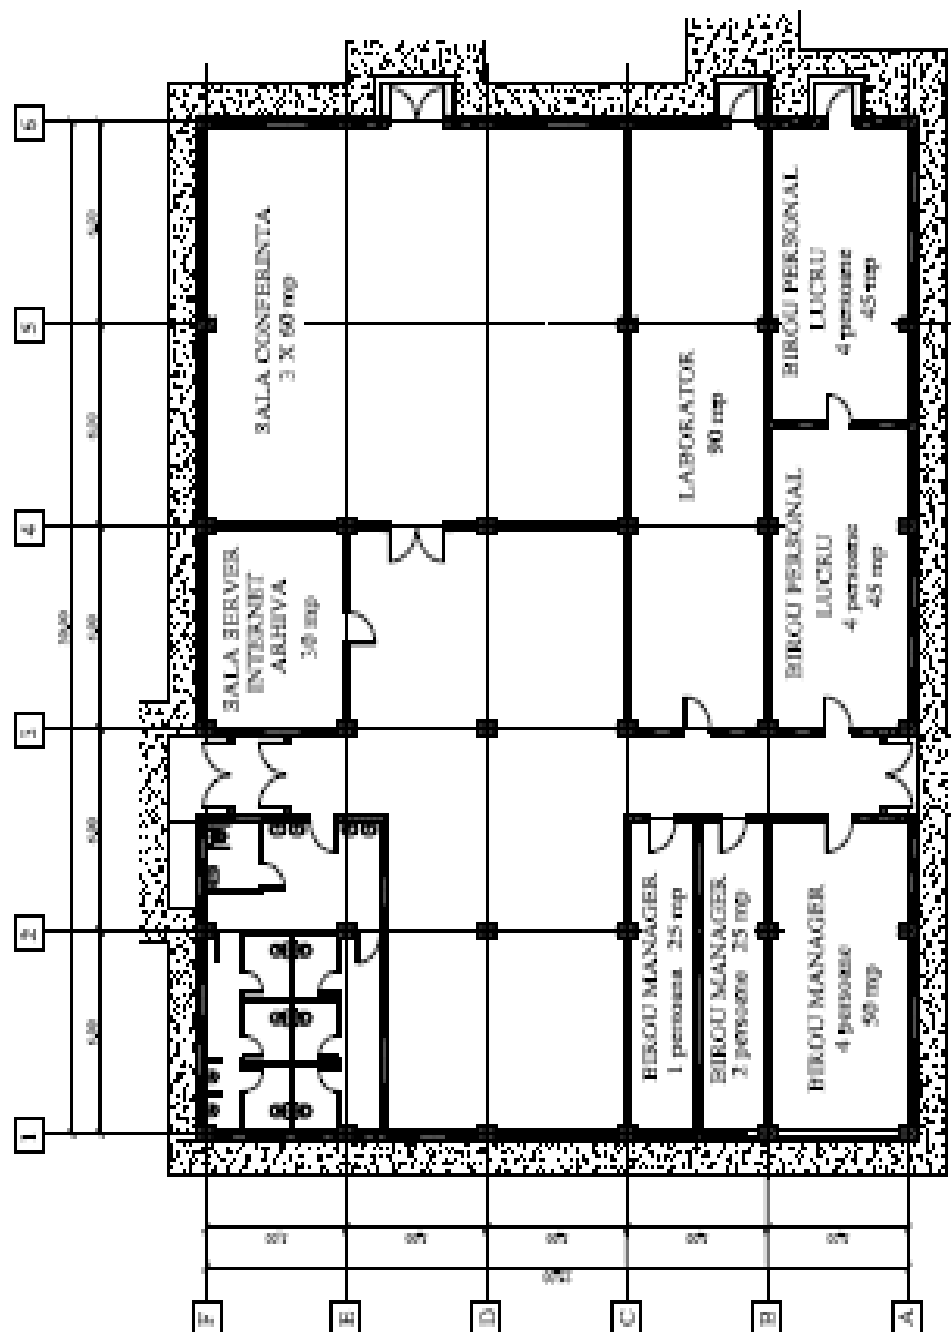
Schiță plan clădire Hub, opțiunea O2
